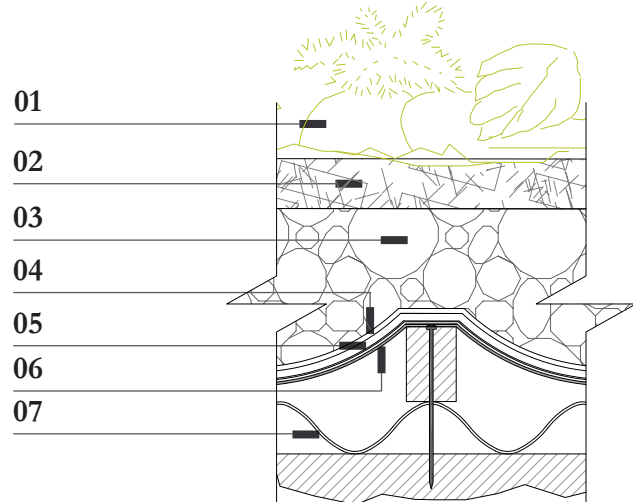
Detalle de capas de cubierta verde (Guzmán & Zuña, 2018)
